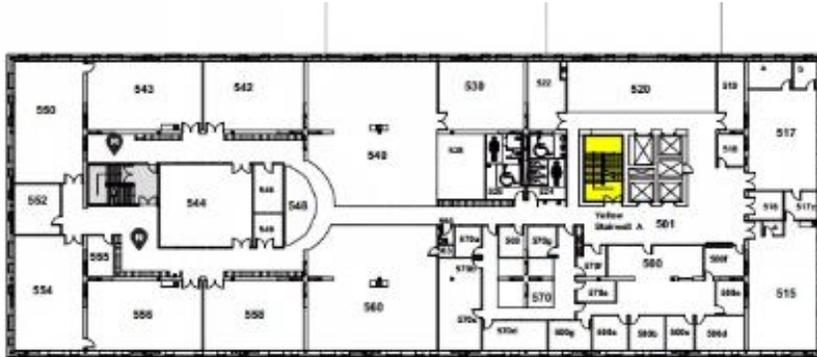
Planta baja arquitectónica. *Nota.* Adaptado de <https://www.waltersgroupinc.com/project/ocad/>
